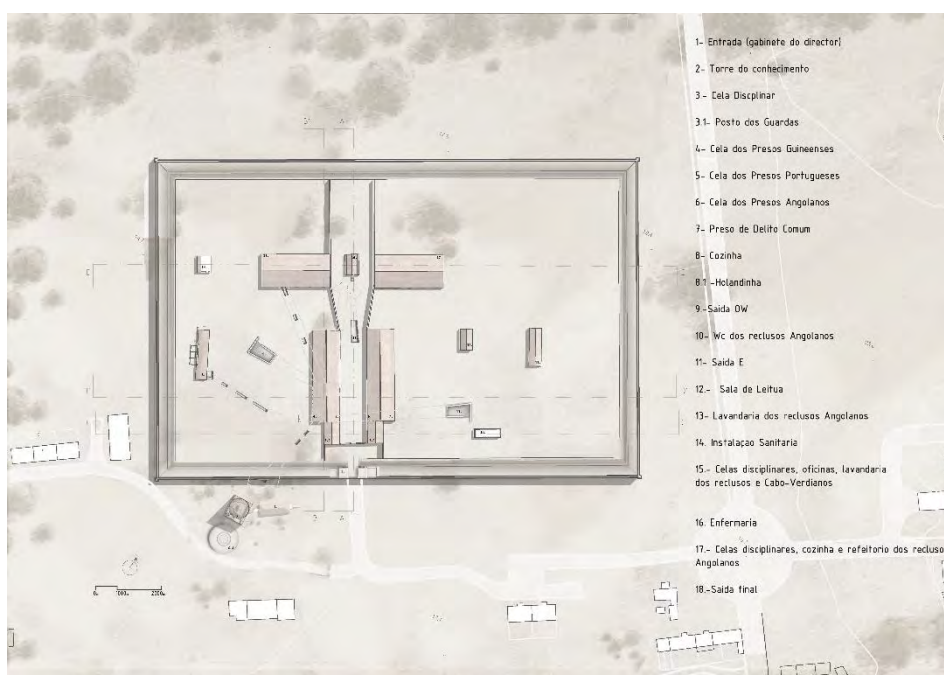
PLANTA DE IMPLANTAÇÃO DA PROPOSTA
